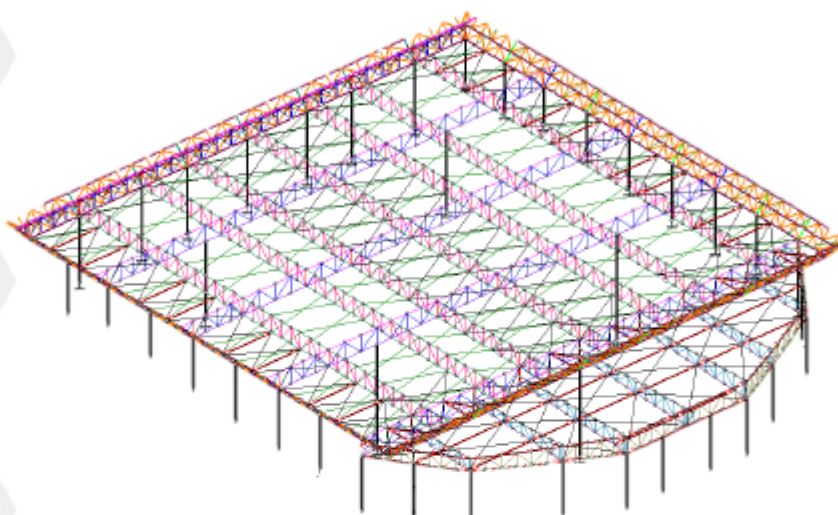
Estruturas metálicas de cobertura – Fonte: Vieira Mello (2022)
